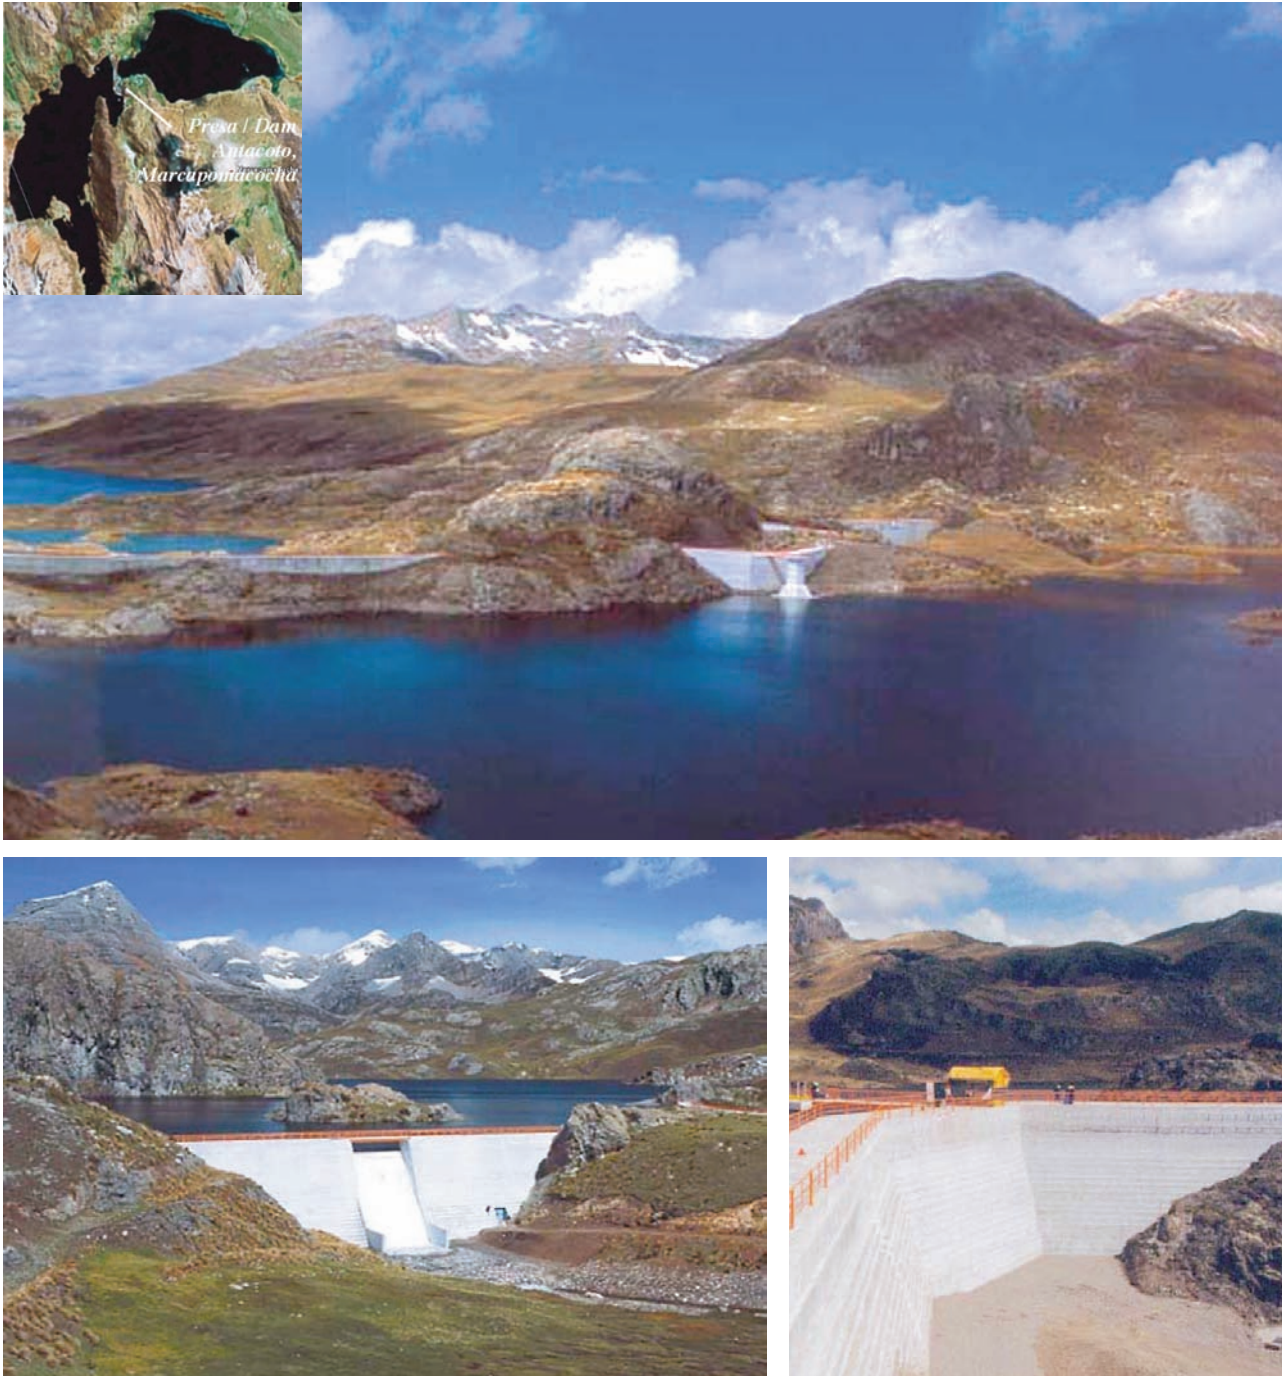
Primera presa de concreto rolado compactado / First roller compacted concrete dam - RCCD, Antacoto, 1999, 4445 m snm / m asl. (Fotos fuente / Photos source: Google Earth 2007; SEDAPAL, 2003).
